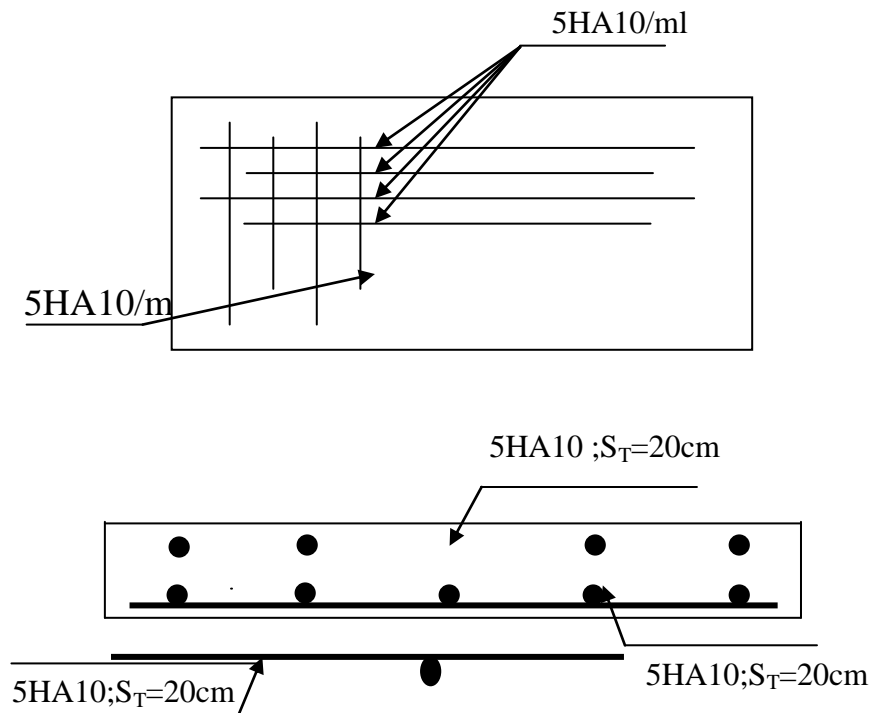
Schéma de ferrailage de la dalle sur 2 appuis
